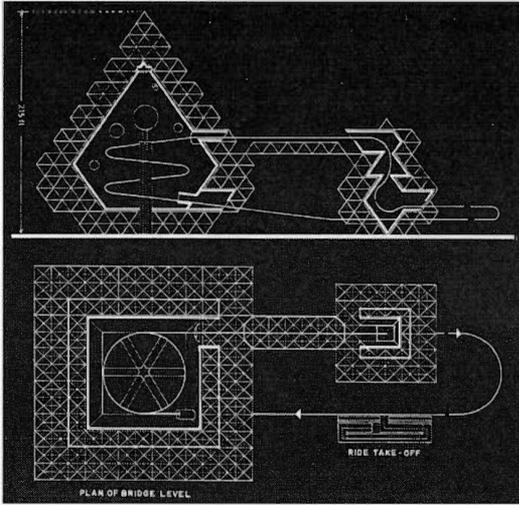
Coupe et plan du Gyrotron de La Ronde
